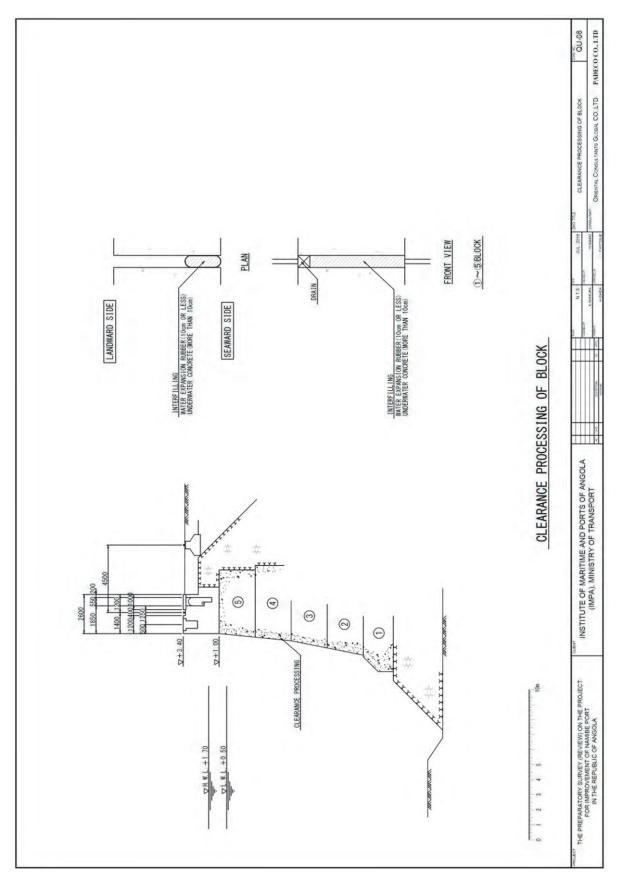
Planta do Método de Obra de Reabilitação dos Blocos do Muro
